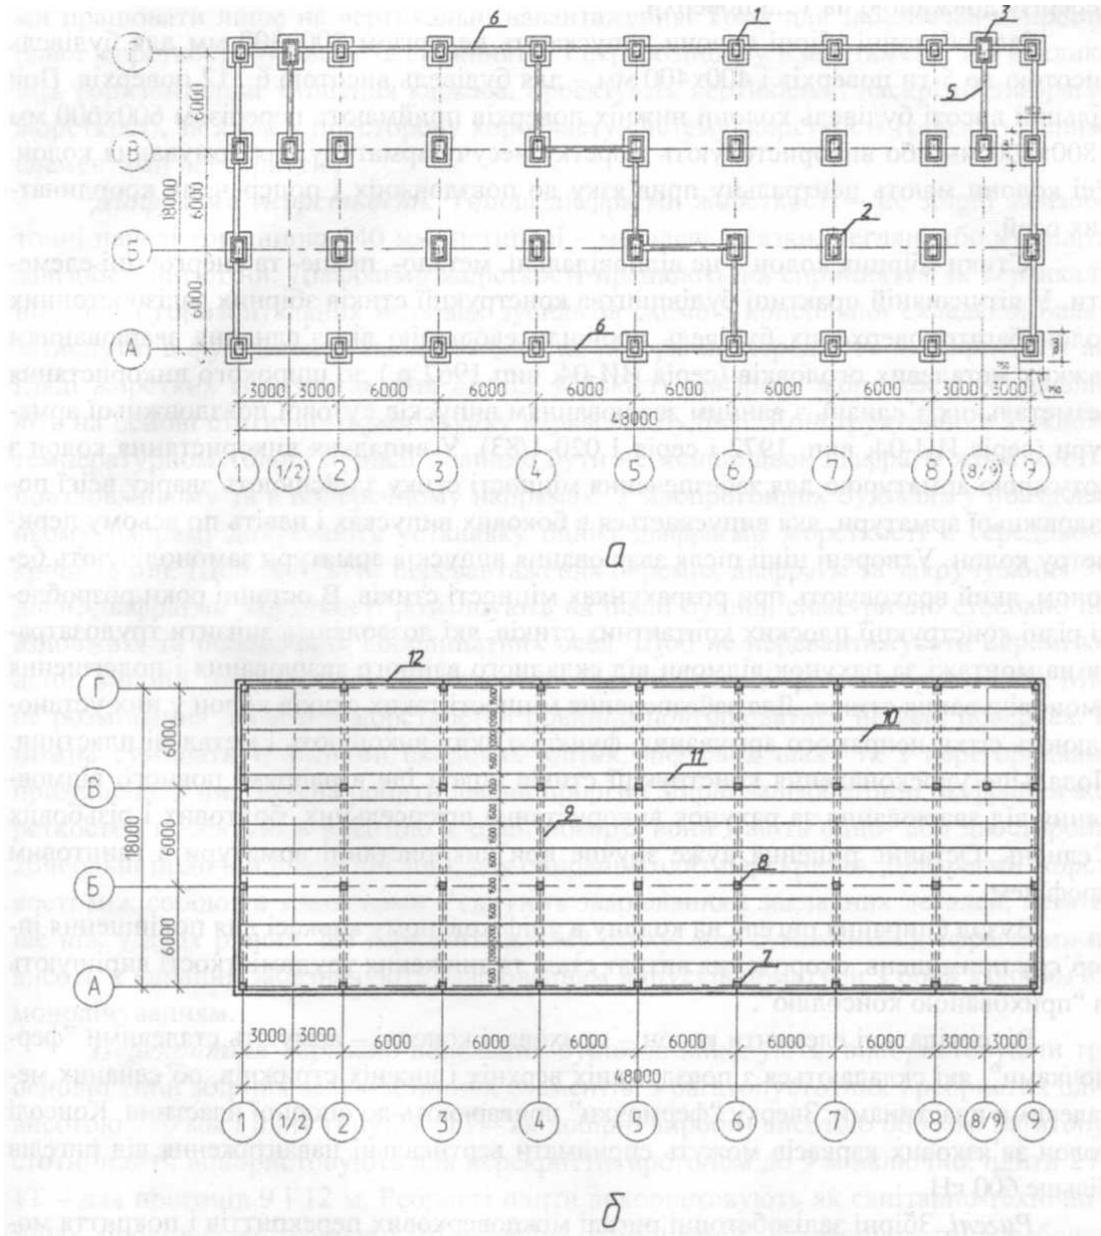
Багатоповерхова промислова будівля із зв'язковим залізобетонним каркасом:
